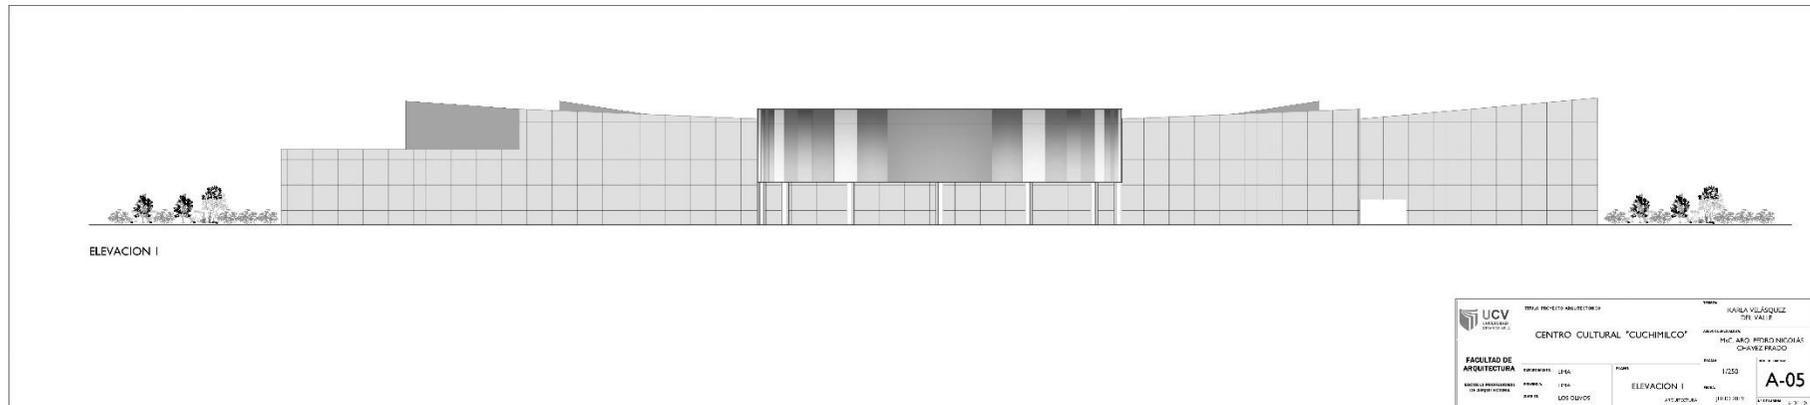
Plano de Arquitectura Elevación 1. Elaboración propia
